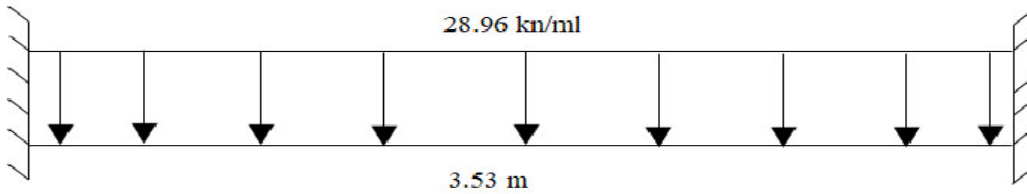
Schéma Statique de la poutre palière (escalier type 01)
